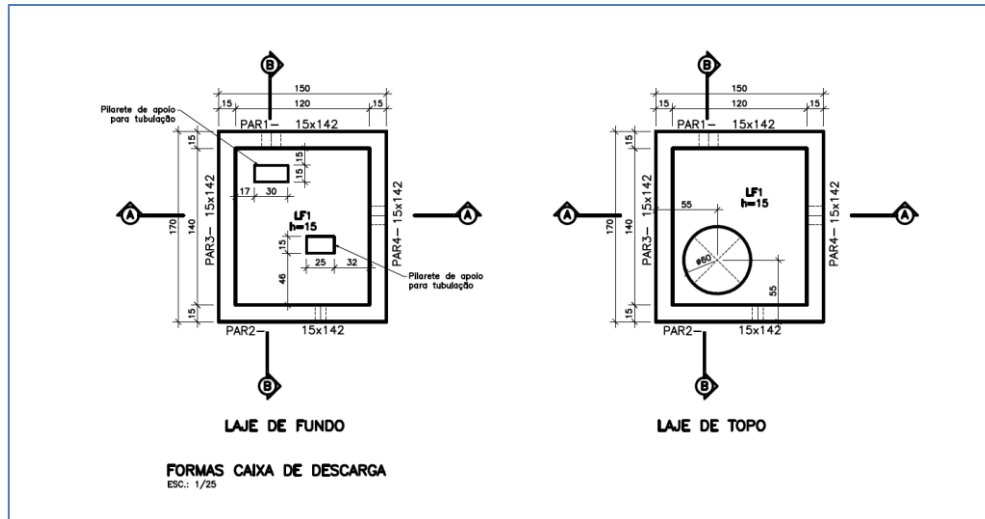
Planta das lajes de fundo e topo da caixa de descarga – EEEB2
